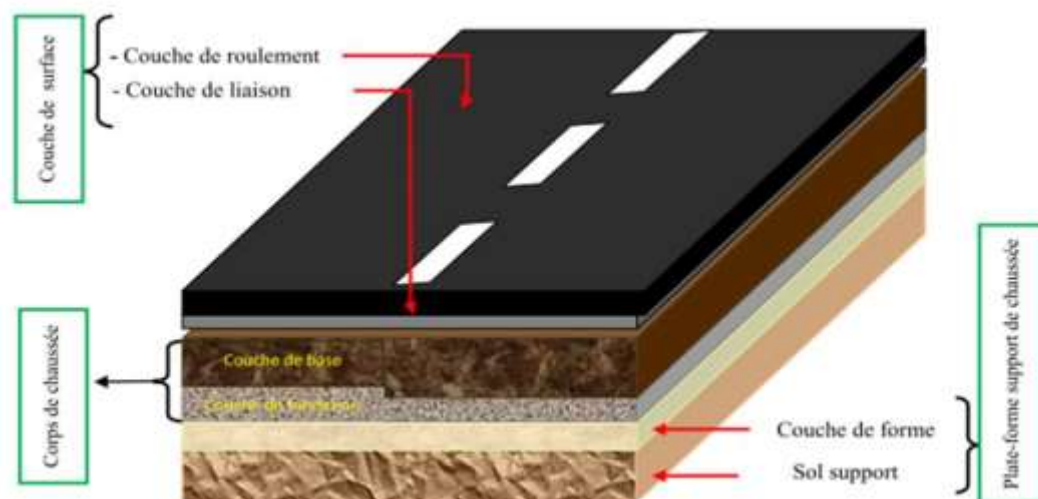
Schéma structural d'une chaussée revêtue (Fadoul, 2012)
